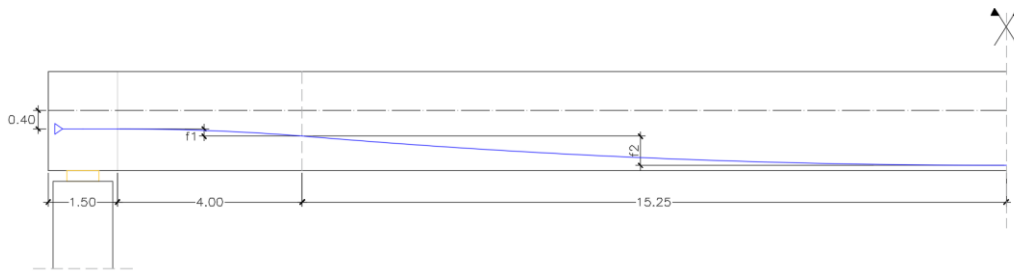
Traçado dos cabos de pré-esforço (nível inferior) nas vigas dos alinhamentos 1 e 2.
